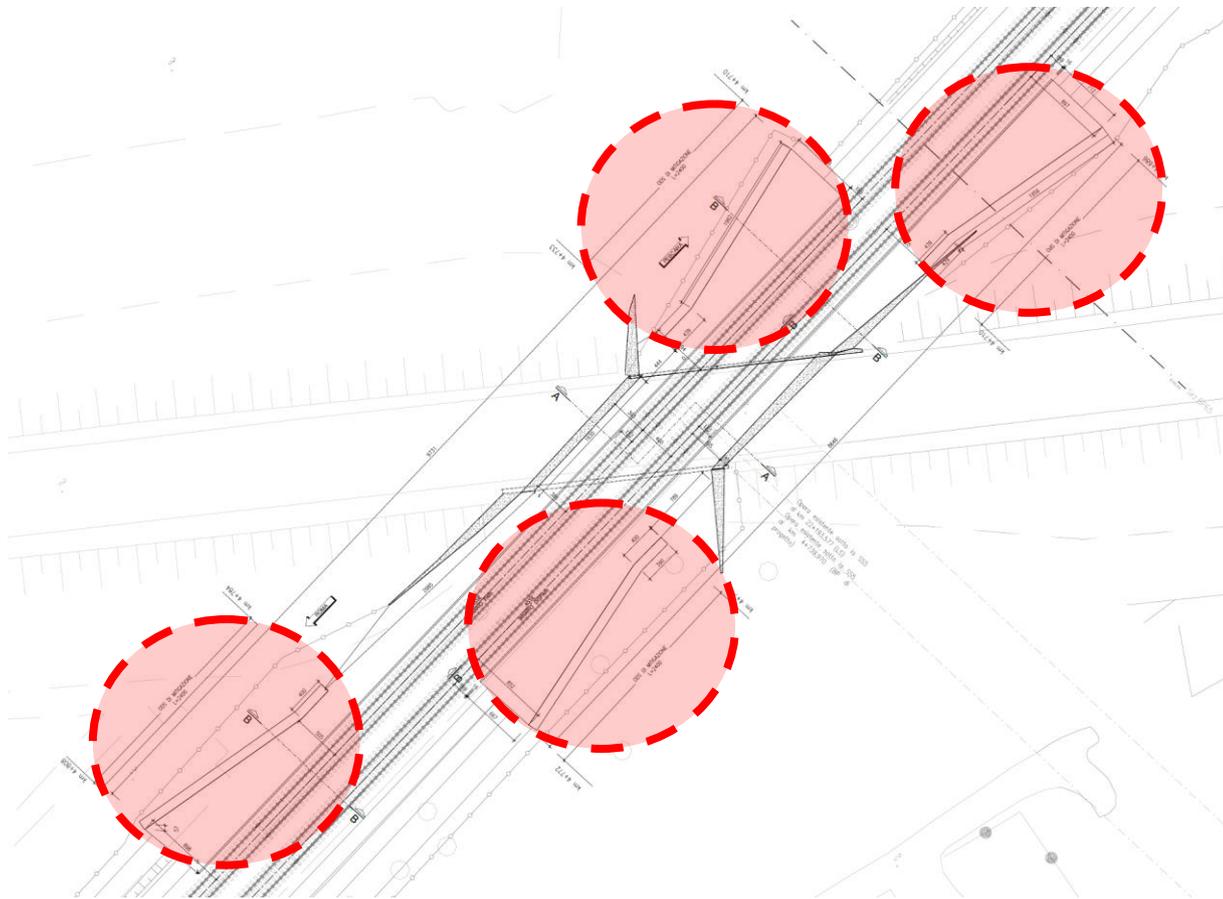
Dettaglio protezione muri andatori spalla esistente
